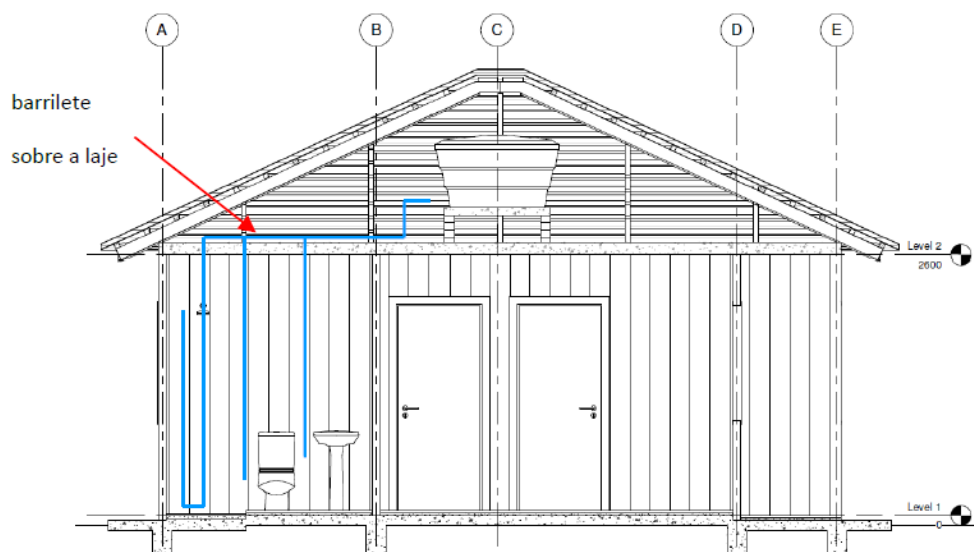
Exemplo de localização do reservatório para água potável e barrilete sobre a laje de concreto.
